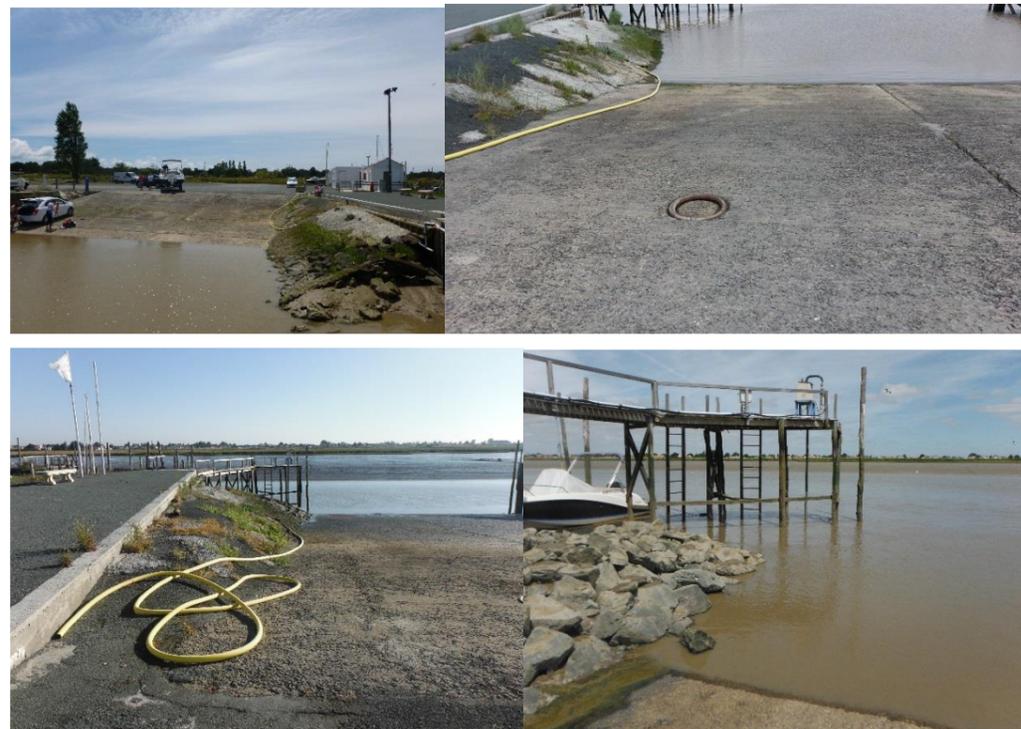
Cale de mise à l'eau de La Faute sur Mer
